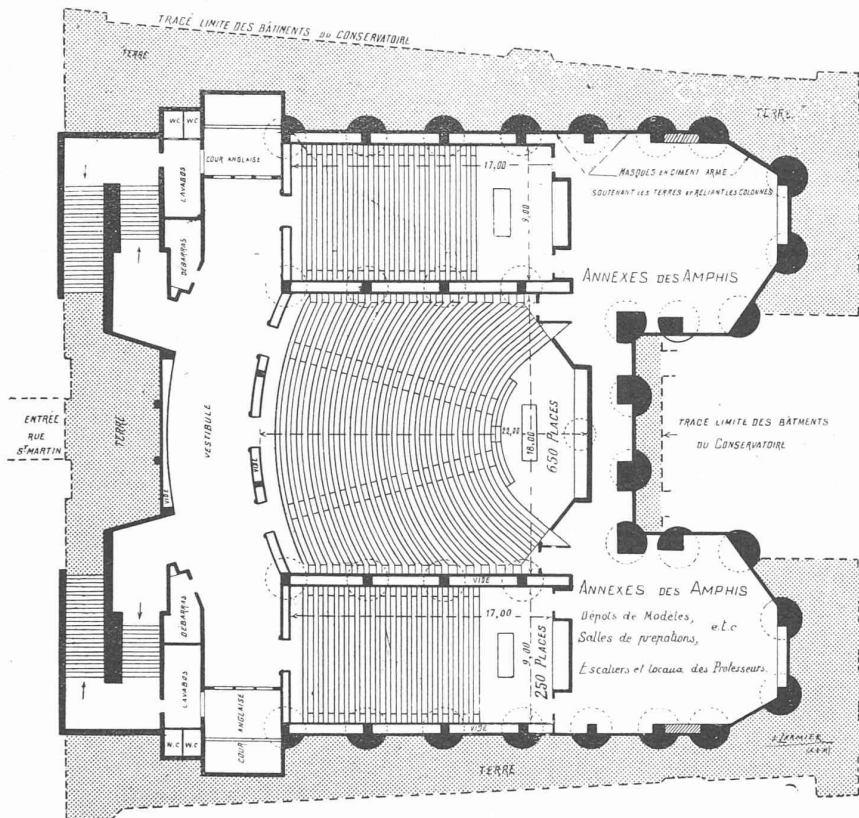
Plan schématique du gros œuvre en ciment armé des 3 nouveaux amphithéâtres construits en sous-sol, sous la cour d'honneur du Conservatoire des Arts et Métiers, à Paris. — Plafond supposé enlevé.
